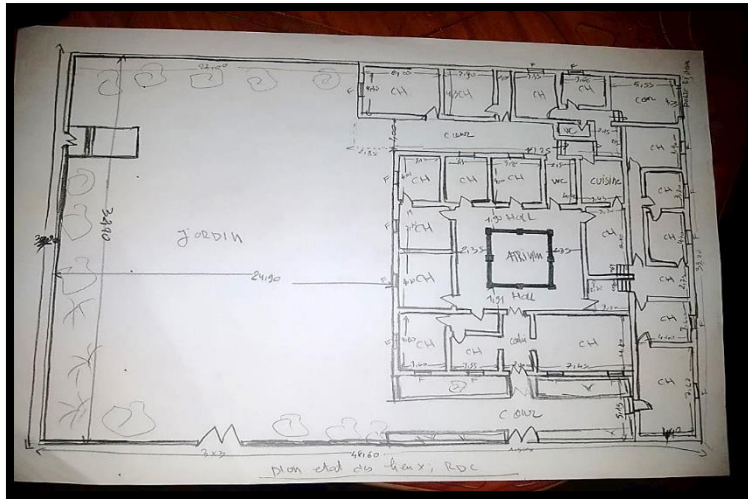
Dessin a main levée du plan état des lieux : Rez-de-chaussée
